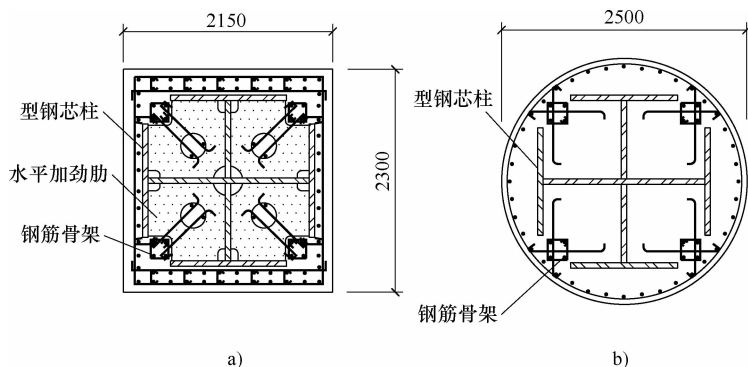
型钢混凝土柱的型钢芯柱和配筋
